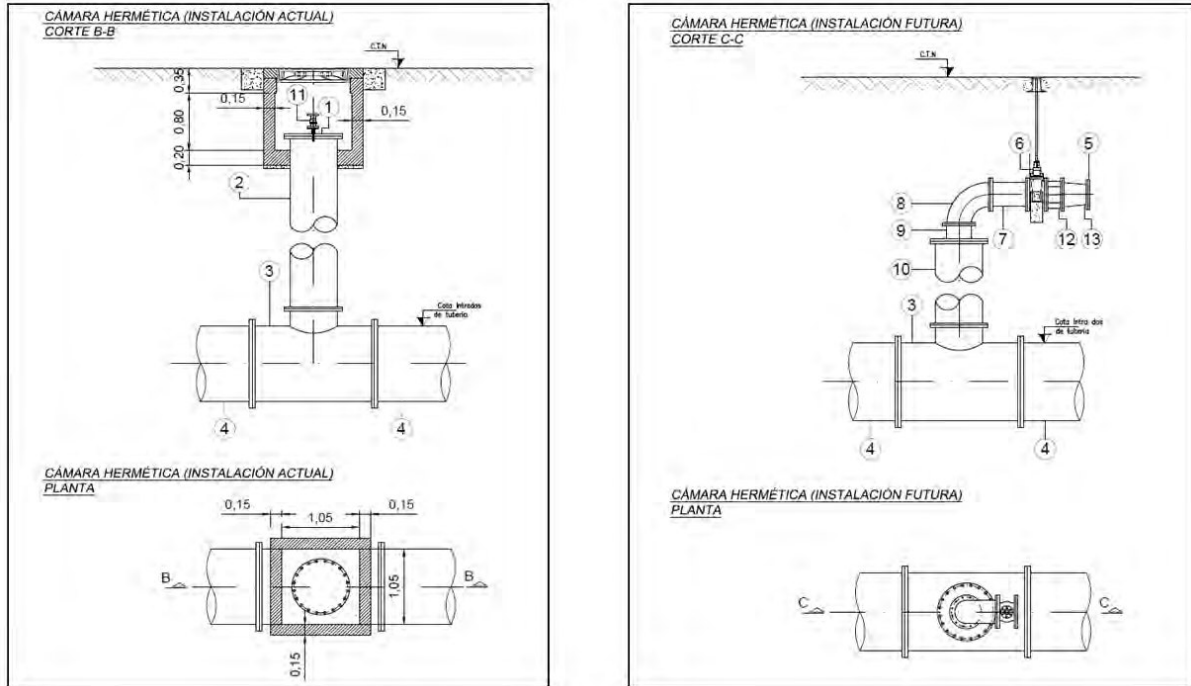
Empalme a cañería existente con adaptación sobre cámara de inspección
